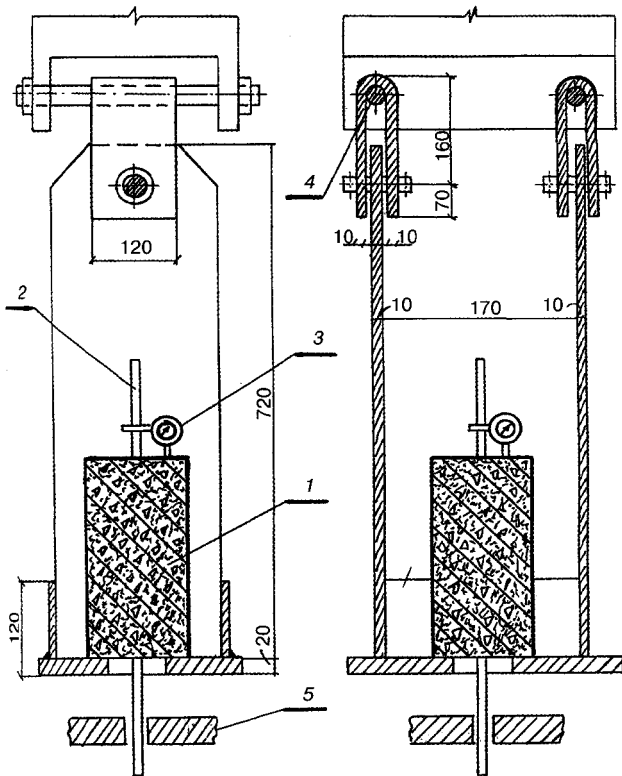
Схема испытания образцов на сцепление арматуры с бетоном: 1 - бетонная призма; 2 - арматурный стержень; 3 - индикатор; 4 - штанги пресса; 5 - нижние зажимы пресса
